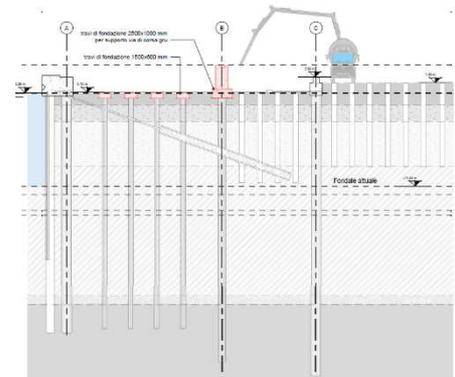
Sezione con indicazione delle travi in c.a. di progetto.
